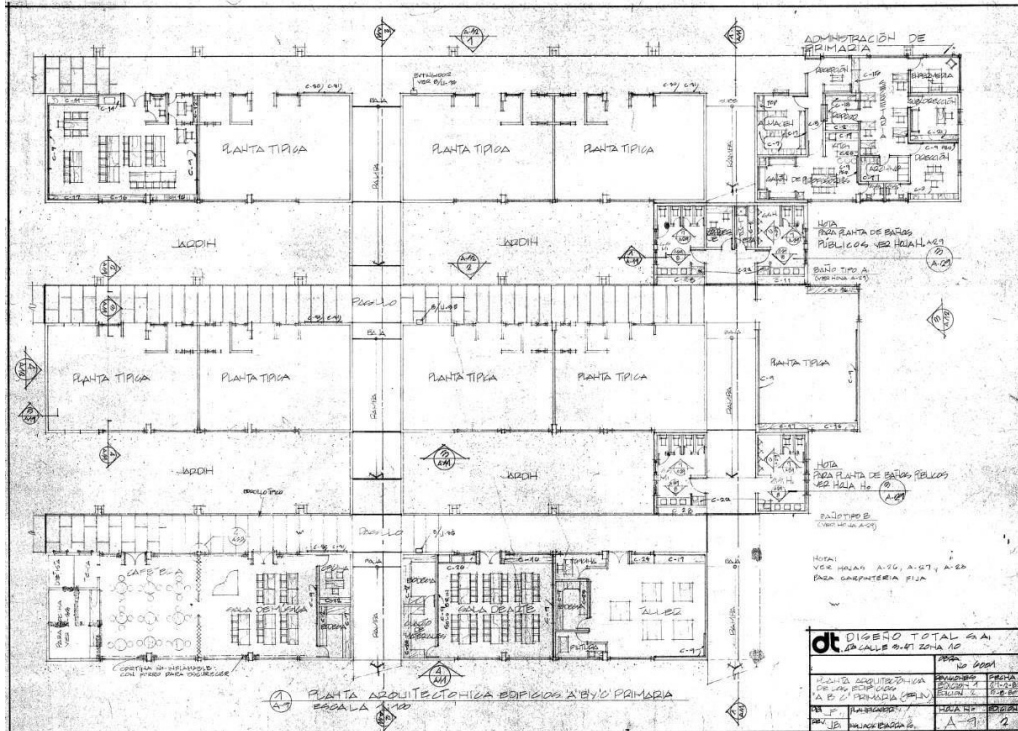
Planta arquitectónica de edificios A, B y C primaria
